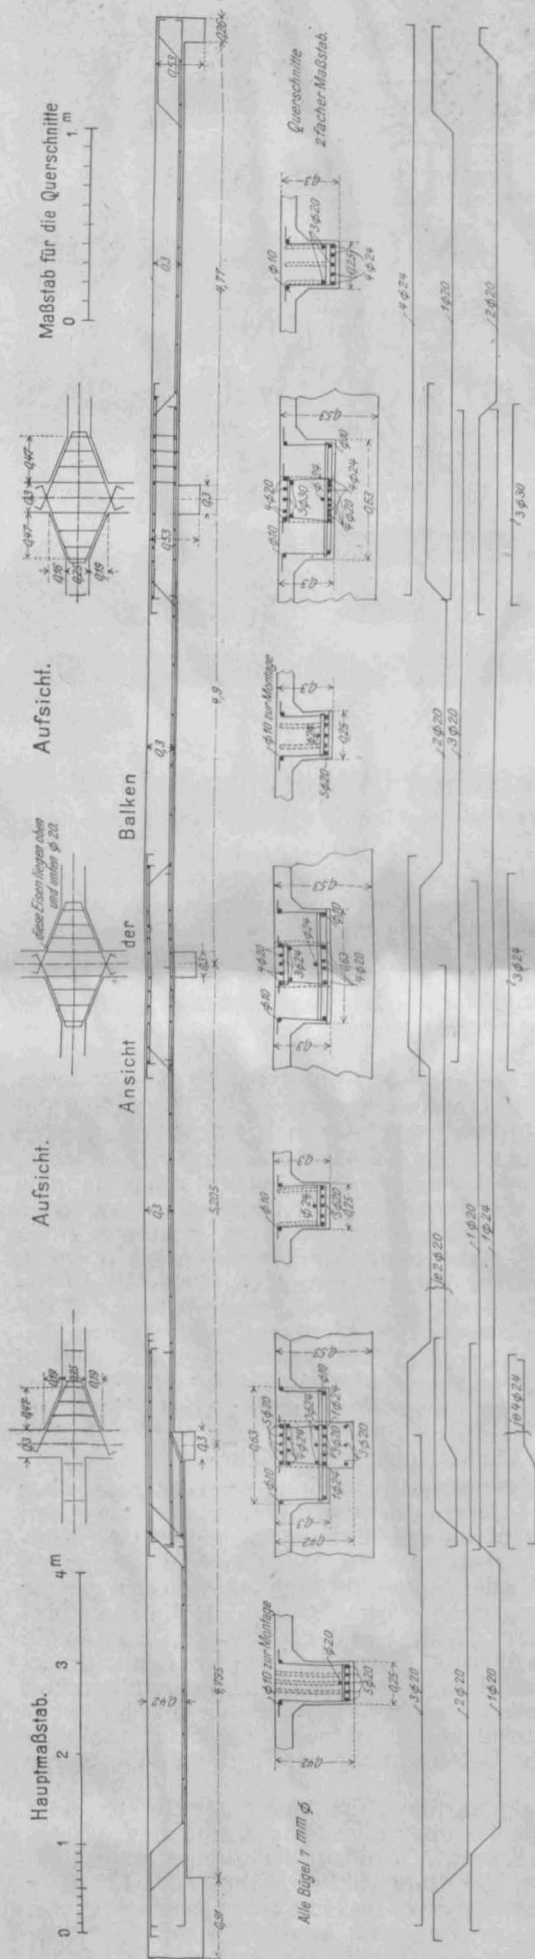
Ausbildung der Deckenbalken der Erdgeschoß-Decke im Verbindungsbau. (Wegen mangelnder Höhe sind statt der Vouten in der lotrechten Ebene Verstärkungen in der wagrechten Ebene eingelegt.) Eisenbeton-Konstruktionen vom Bau der deutschen Bücherei zu Leipzig.
